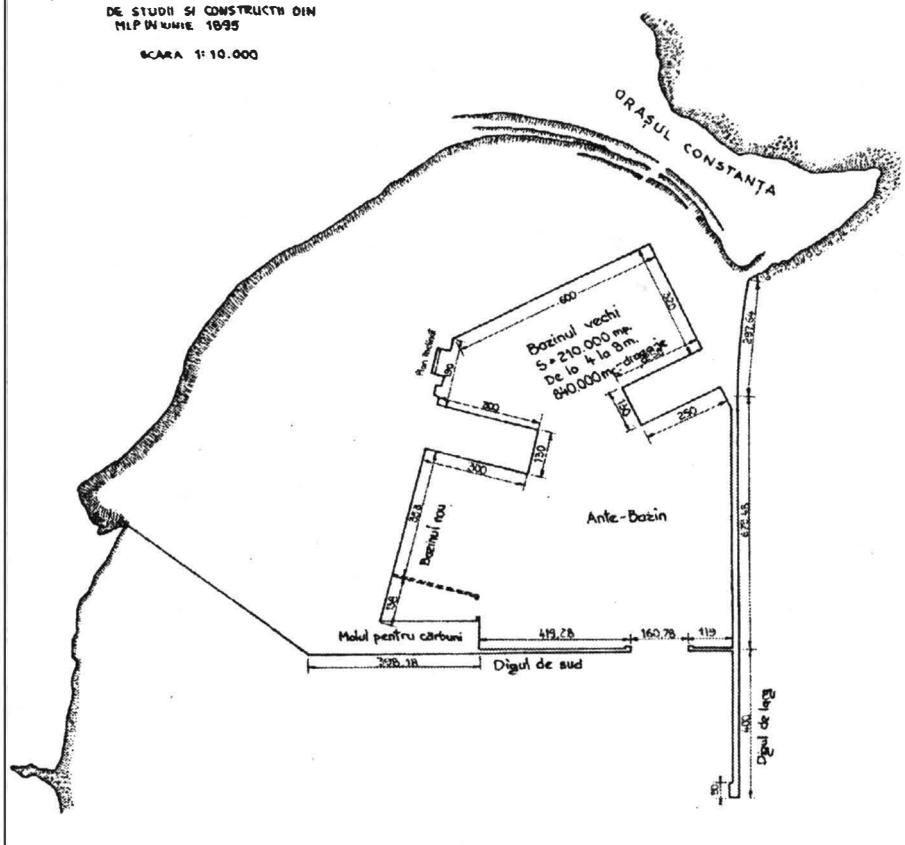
Planul Portului Constanța scos la licitație în 1895 (Adrien Hallier).
